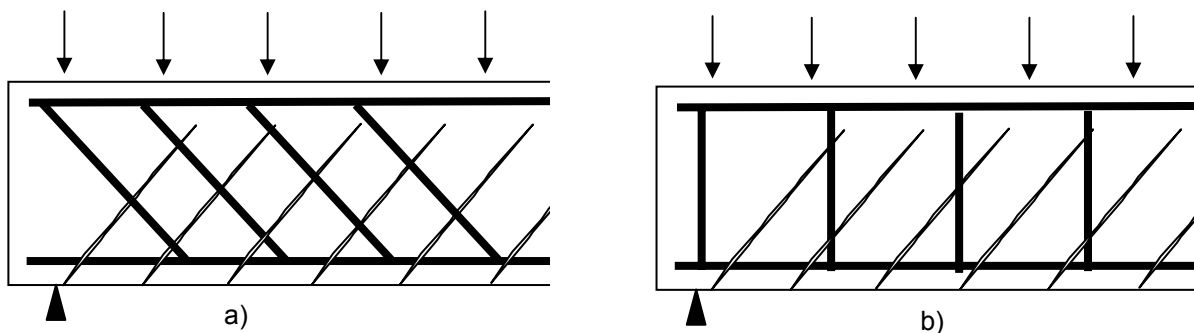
Formación de fisuras y cosido con la armadura transversal
